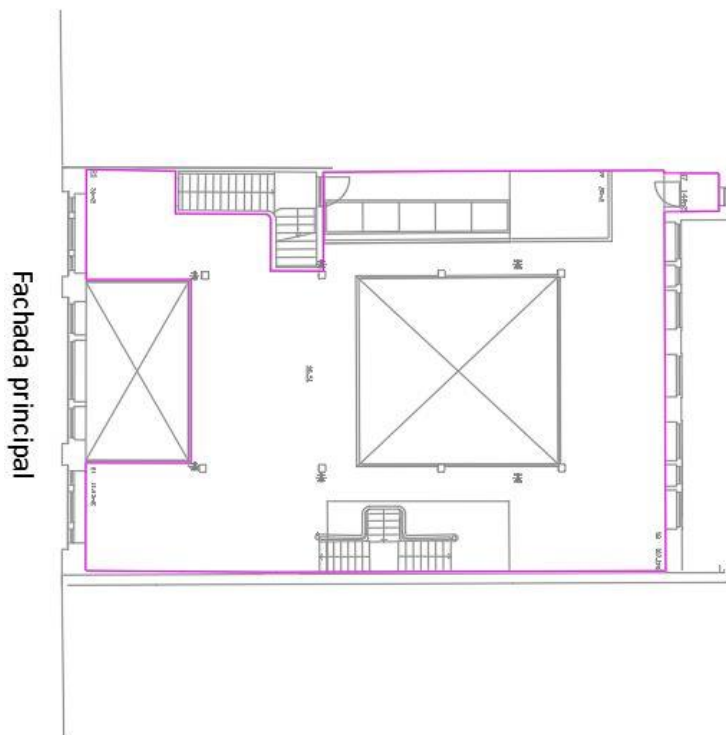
Planta arquitetônica do piso 1 da fração H
